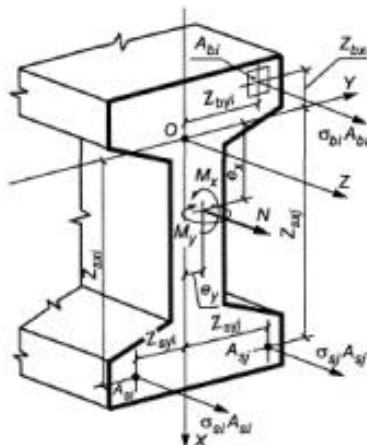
Расчетная схема нормального сечения предварительно напряженного железобетонного элемента
